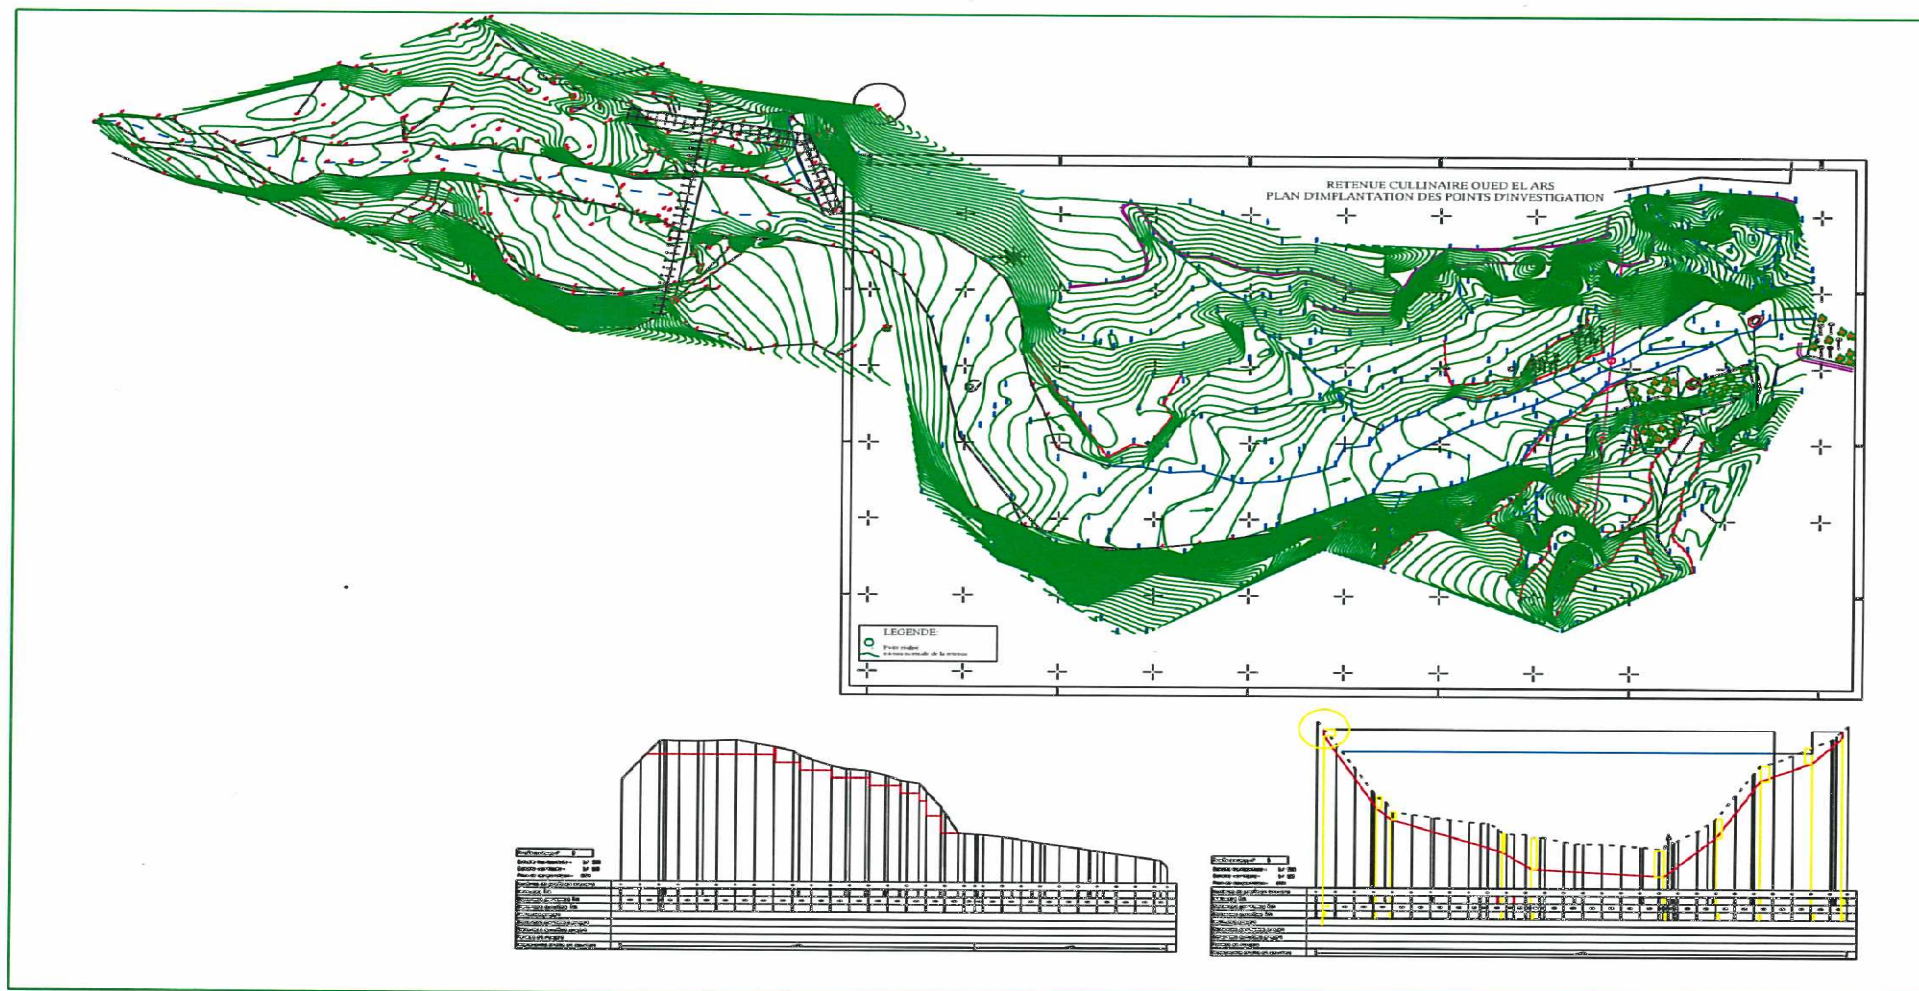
Retenue collinaire Oued Laars (profil en travers , profil en long)
